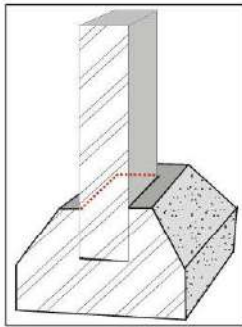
Detalhe da inserção do pilar no elemento de fundação
